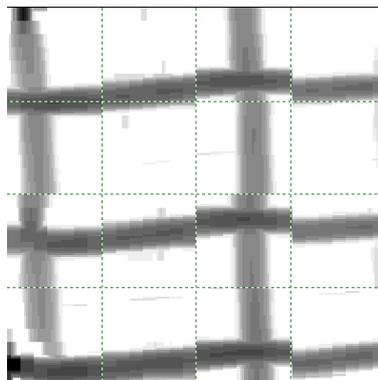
Viga. Fuente: Equipo Ferroscaan.
